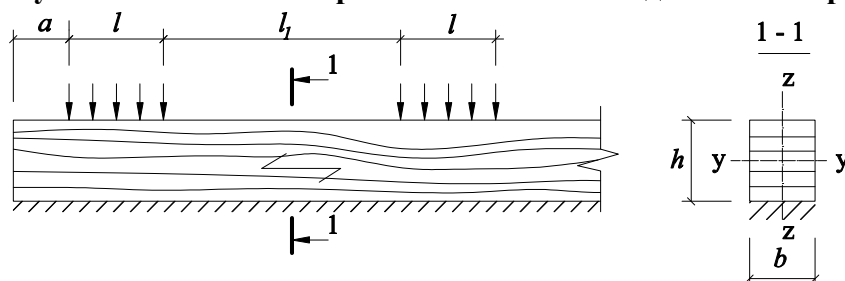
Схема опирания элемента на сплошную опору
